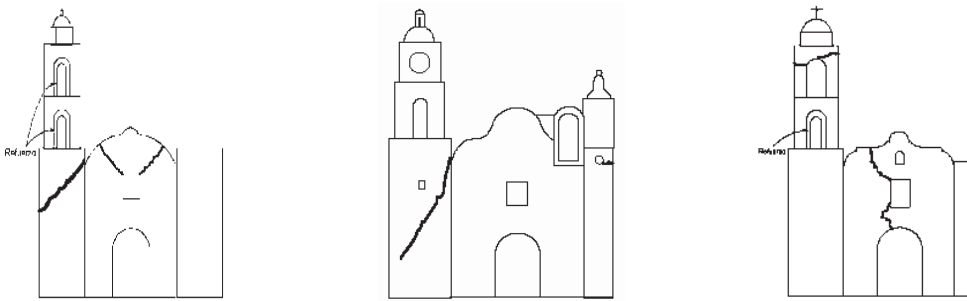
Mecanismo de falla y reforzamiento de elementos arquitectónicos estructurales
